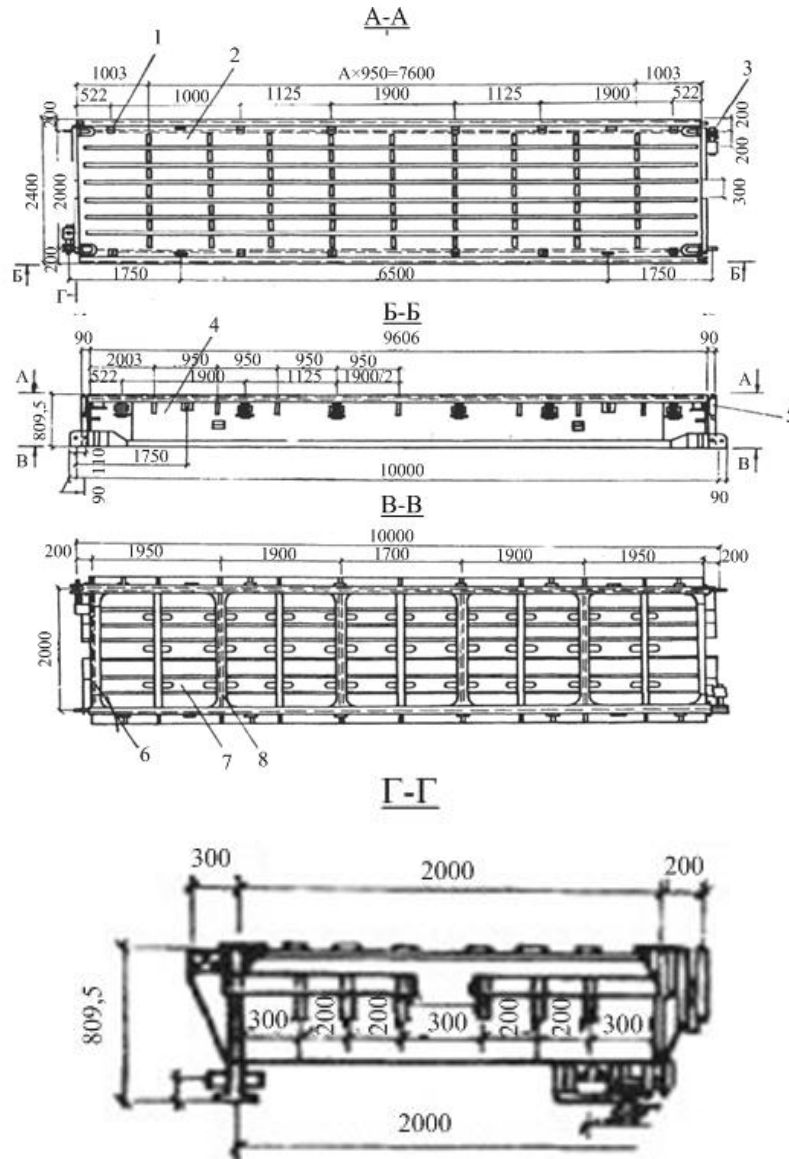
Блок прогонової будови: 1 – гніздо для встановлення колесовідбоїв; 2 – лист проїзної частини; 3 – стиковий пристрій; 4 – головна поздовжня балка; 5 – балка Б1-1; 6 – торцева поперечна балка; 7 – проміжна поздовжня балка; 8 – проміжна поперечна балка
